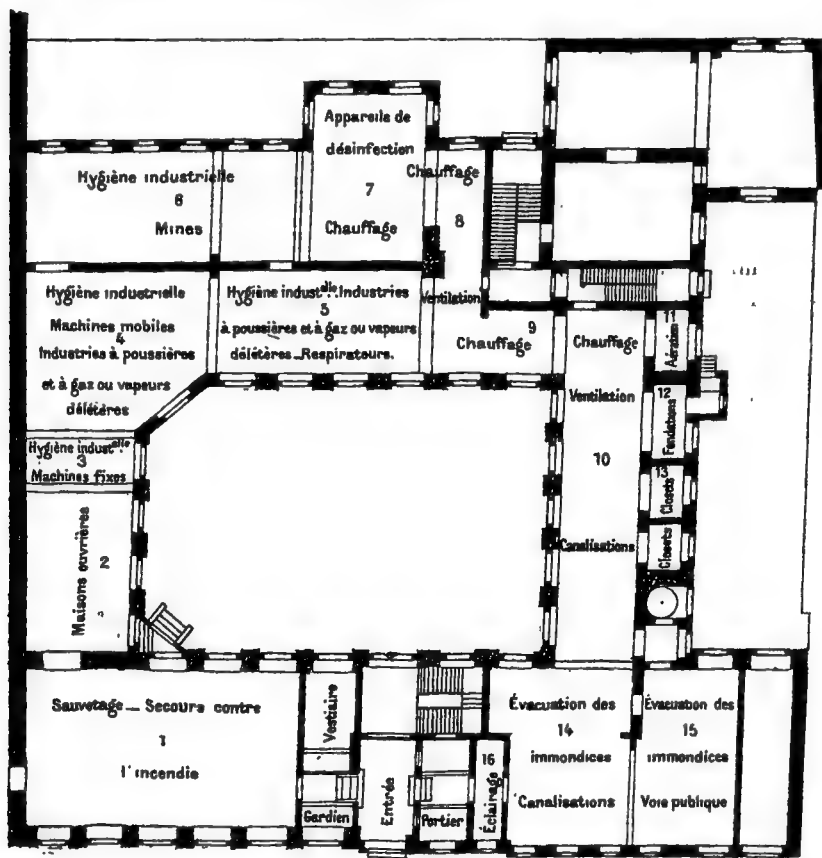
Musée d'hygiène de Berlin. — Plan du rez-de-chaussée.
